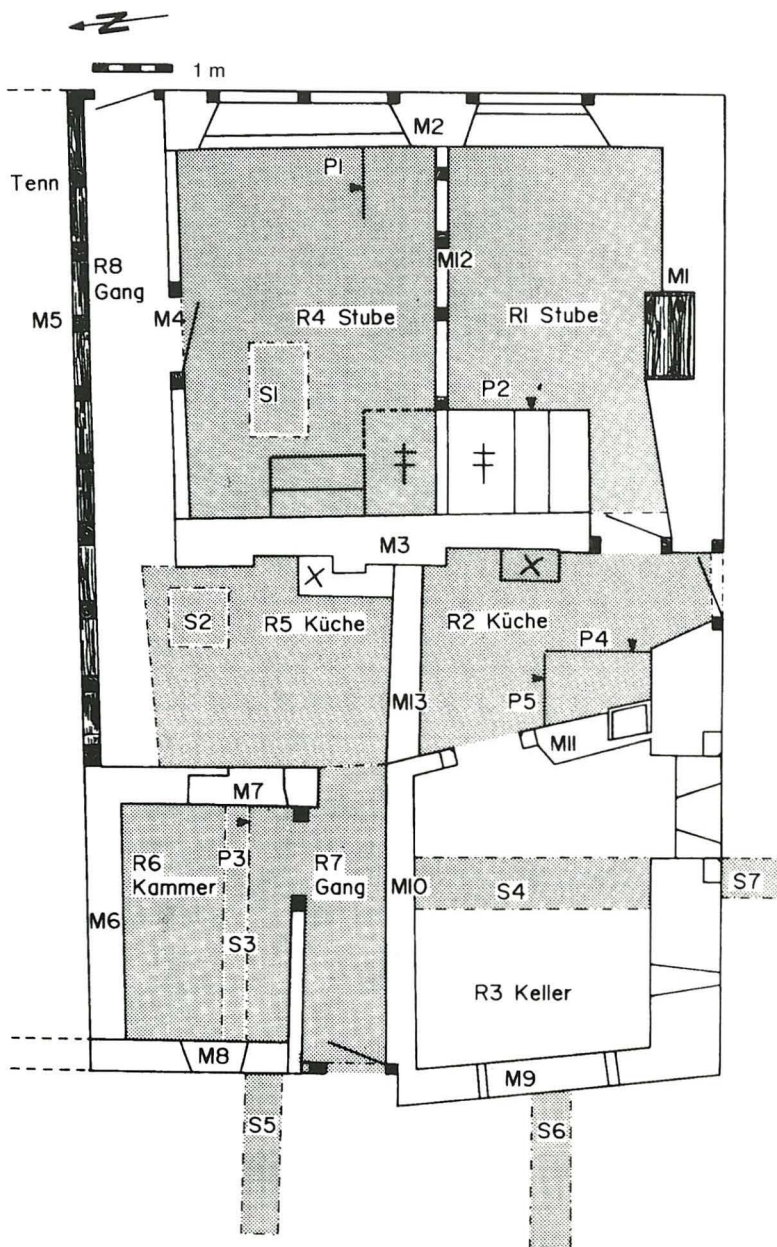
«Hebammenhaus» von Kaisten (AG). Schnitt durch das Erdgeschoss, Grabungsflächen gerastert. (Nach Rigert und Wälchli 1996, Abb. 3.) – Massstab 1 : 100.
